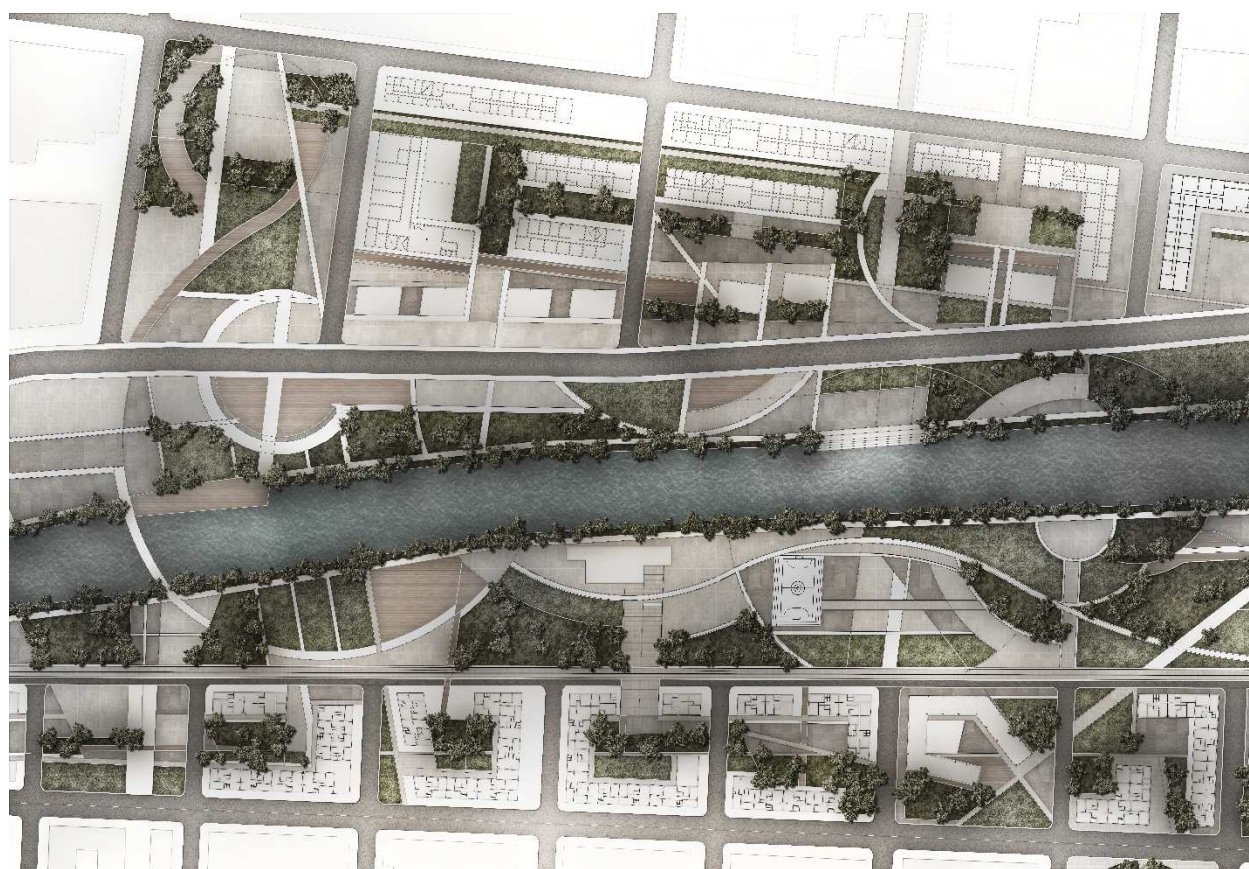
Planta general puntual– Canal Juan Angola (Autoría propia)
